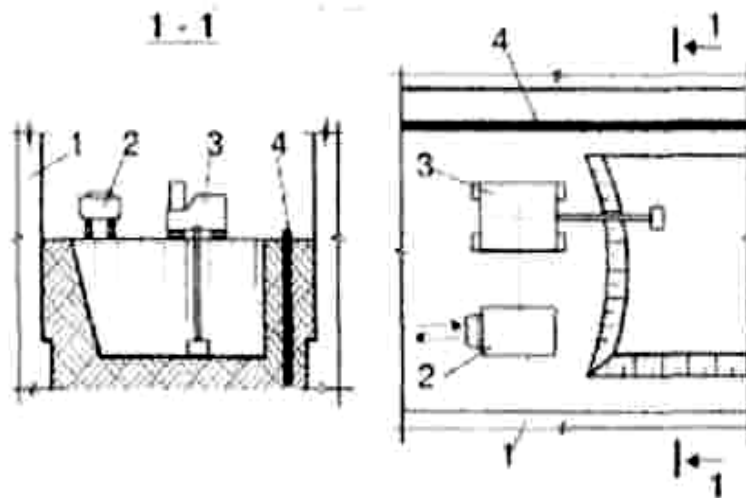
Схема розробки ґрунтів екскаватором поблизу існуючих будівель повздовжньою проходкою: 1 – існуючі будівлі; 2 – автосамоскид; 3 – екскаватор зі зворотною лопатою; 4 – шпунт
